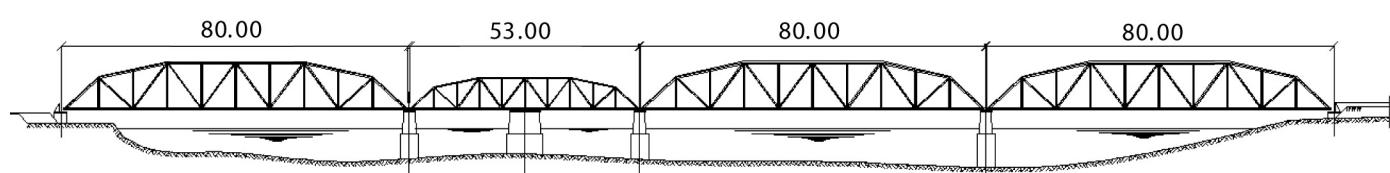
a : Elévation et coupe longitudinale du pont-rails d'Edfina.
